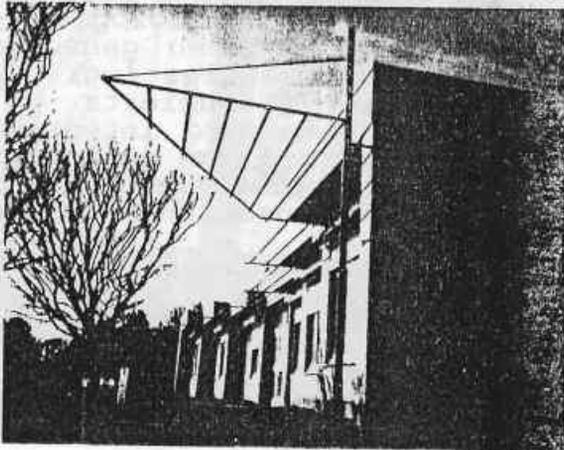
Detalle Constructivo del Paramento y Cubierta del Edificio
